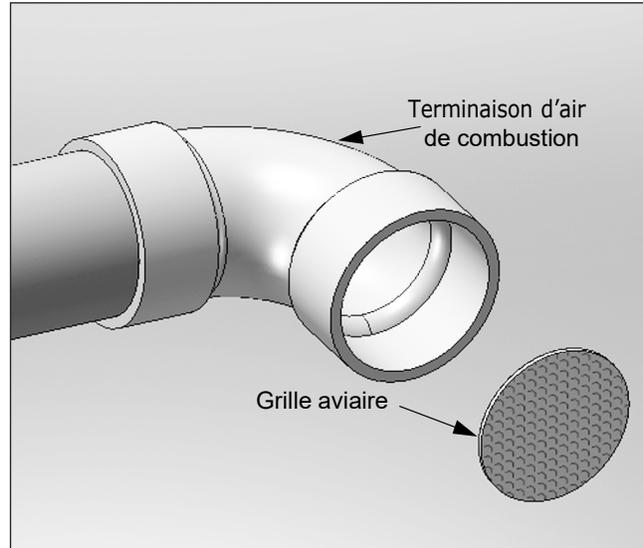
Installation de grille aviaire sur tuyauterie d'air de combustion murale
